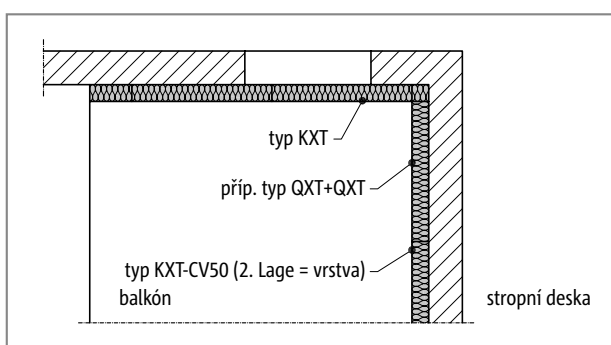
Schöck Isokorb® typ KXT: Volně vyložený balkón
